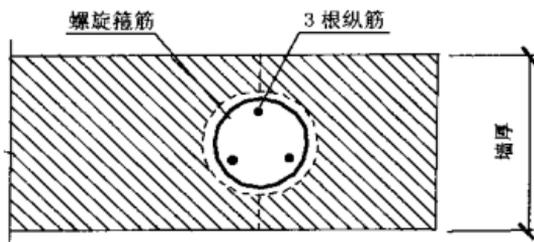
墙体两端构造边缘构件中的纵向受力钢筋
